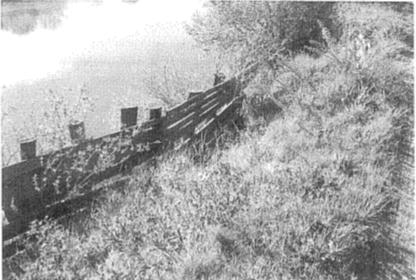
Reforço dos taludes com estruturas de madeira
